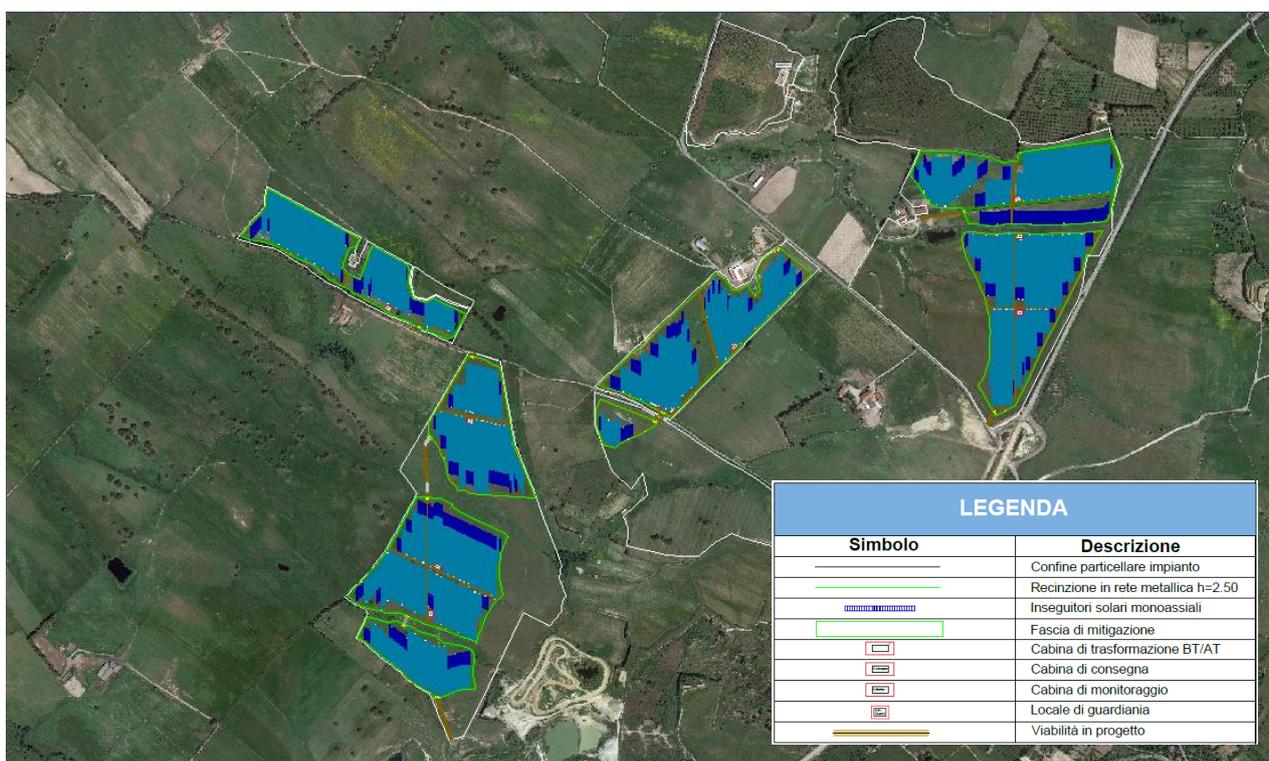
LAYOUT PLANIMETRICO DELL'AREA D'IMPIANTO
